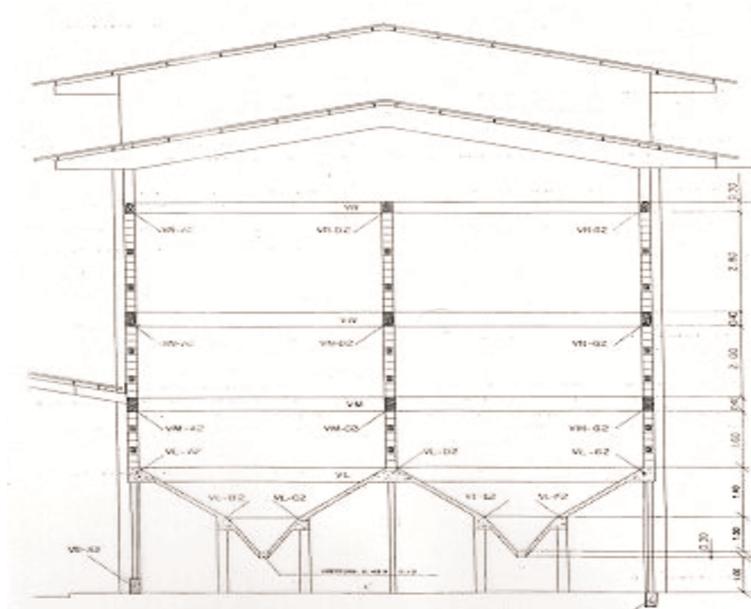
Esquema estrutural do silo multicelular construído em Varginha. Schematic structure of the multi-cell silo built in Varginha.
